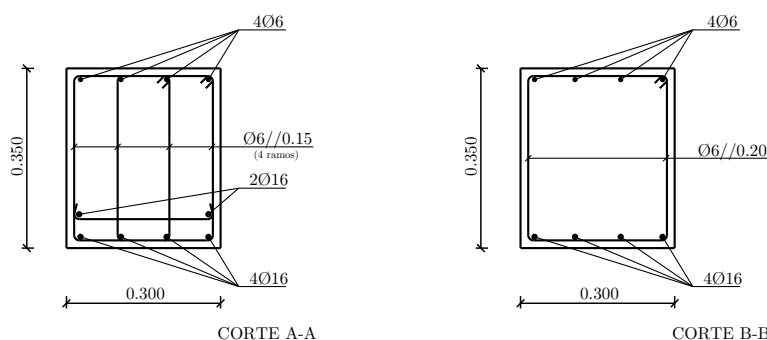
Cortes transversais representativos da geometria e da disposição de armaduras nas duas vigas ensaiadas (ver posição dos cortes na Figura 5.25).
